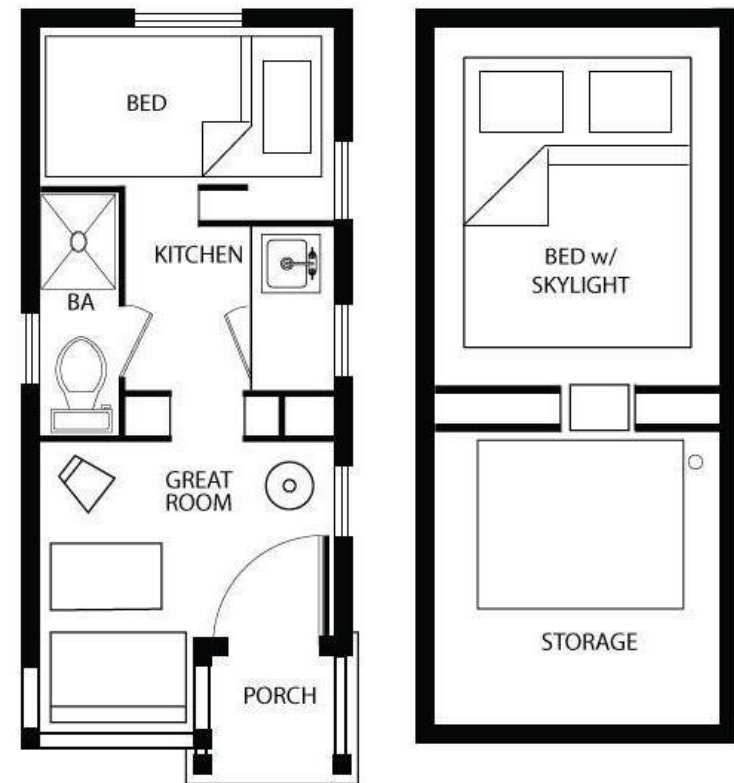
Planta arquitectónica de The weller otro prototipo de Jay Shafer. Fuente: TINY HOUSE TALK. 2014
